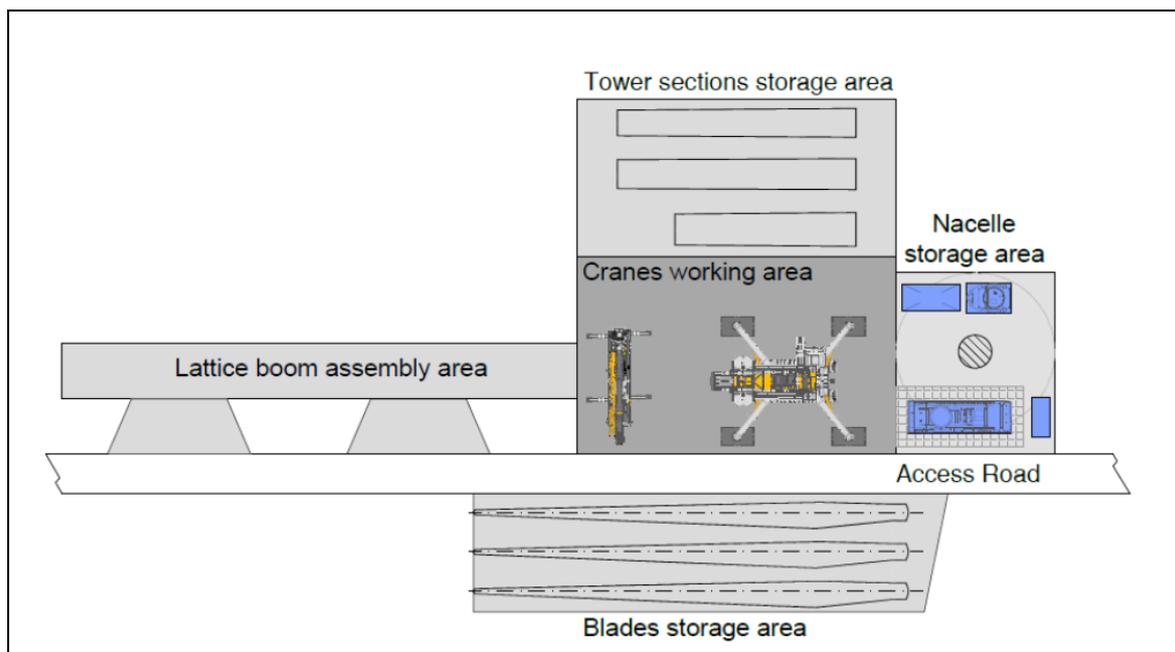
piazzola standard con schema di stoccaggio e montaggio della torre
